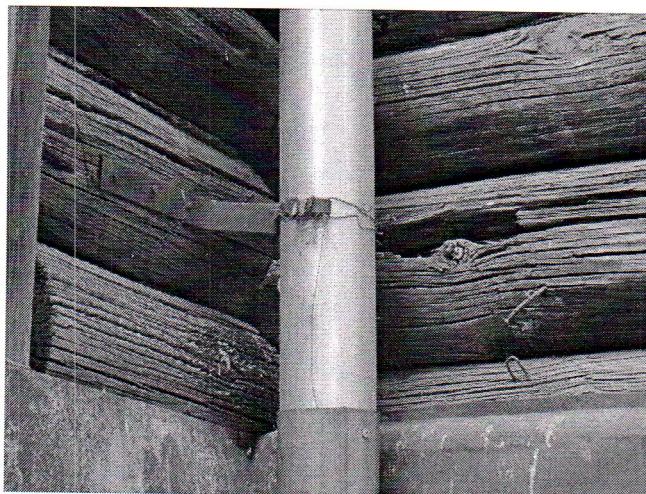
Поражение гнилью нижних венцов сруба на южном фасаде
